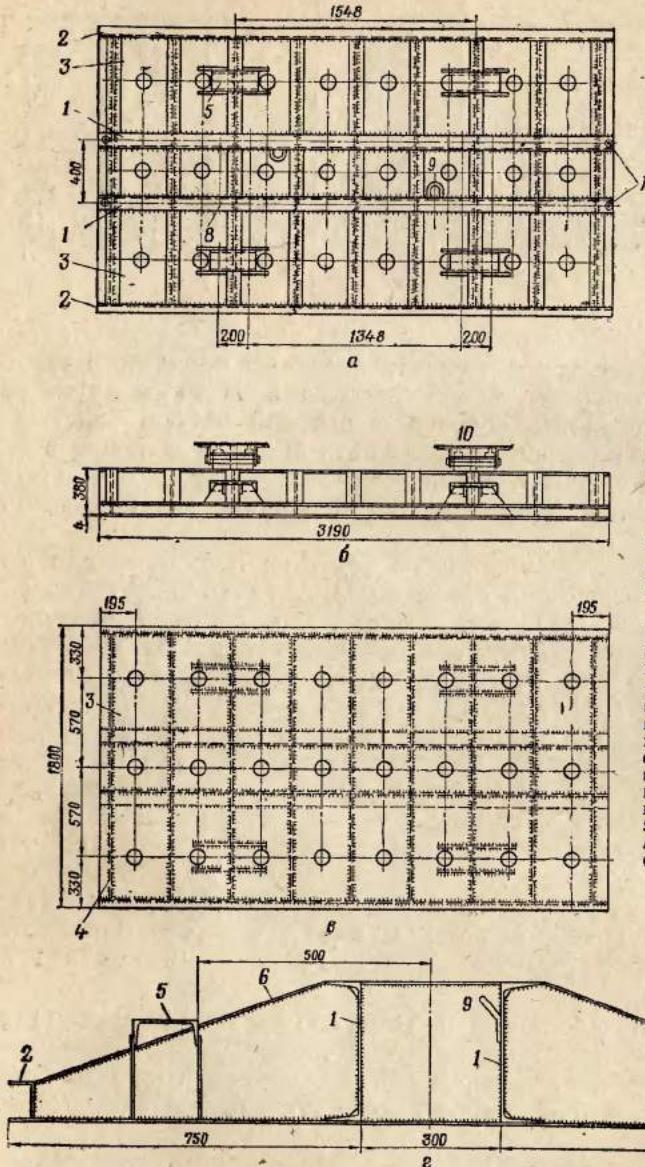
Конструкция берегового лежня (опорной подушки М21):
